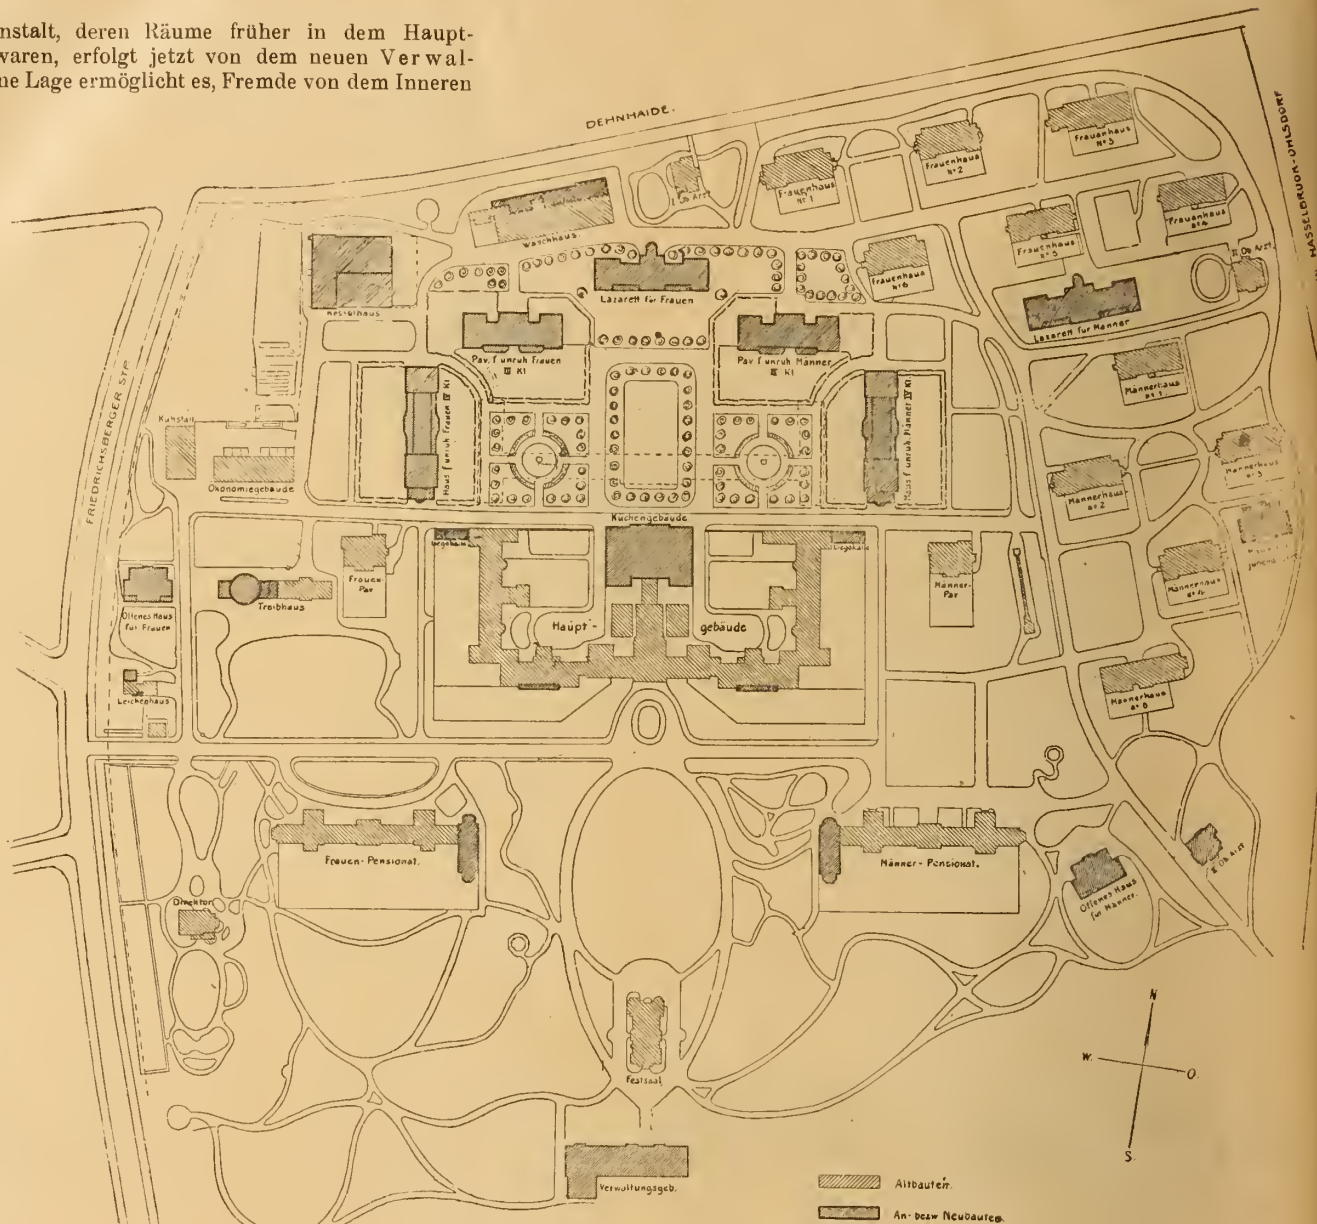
Irrenanstalt Friedrichsberg. Lageplan. (Maßstab rd. 1:3400.)
